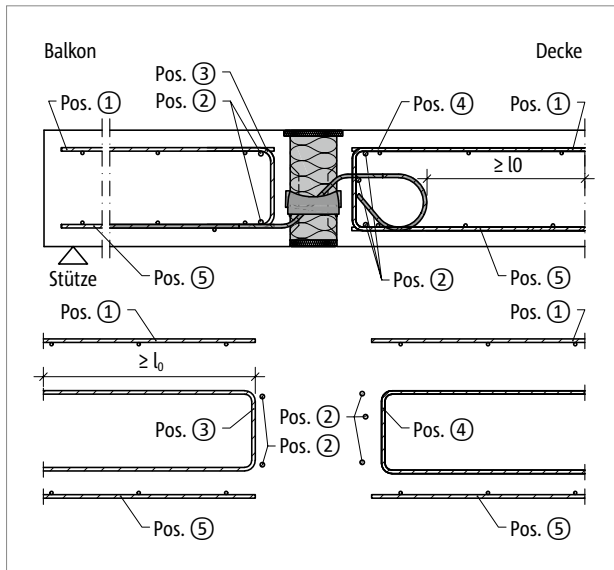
Schöck Isokorb® T Typ QL: Bauseitige Bewehrung
